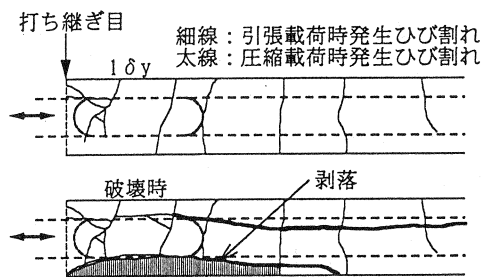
ひび割れ図 (CASE-3 供試体)
